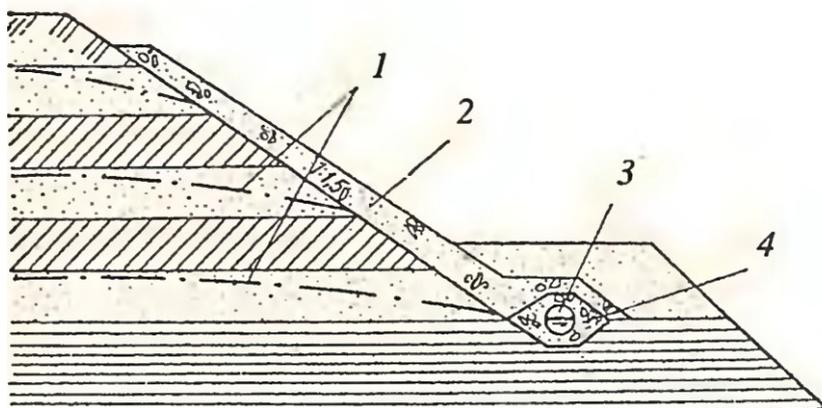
Пластовый дренаж на откосах котлована: 1 - пониженные уровни подземных вод; 2 - песчаная пригрузка; 3 - дренажная труба; 4 - засыпка гравием
